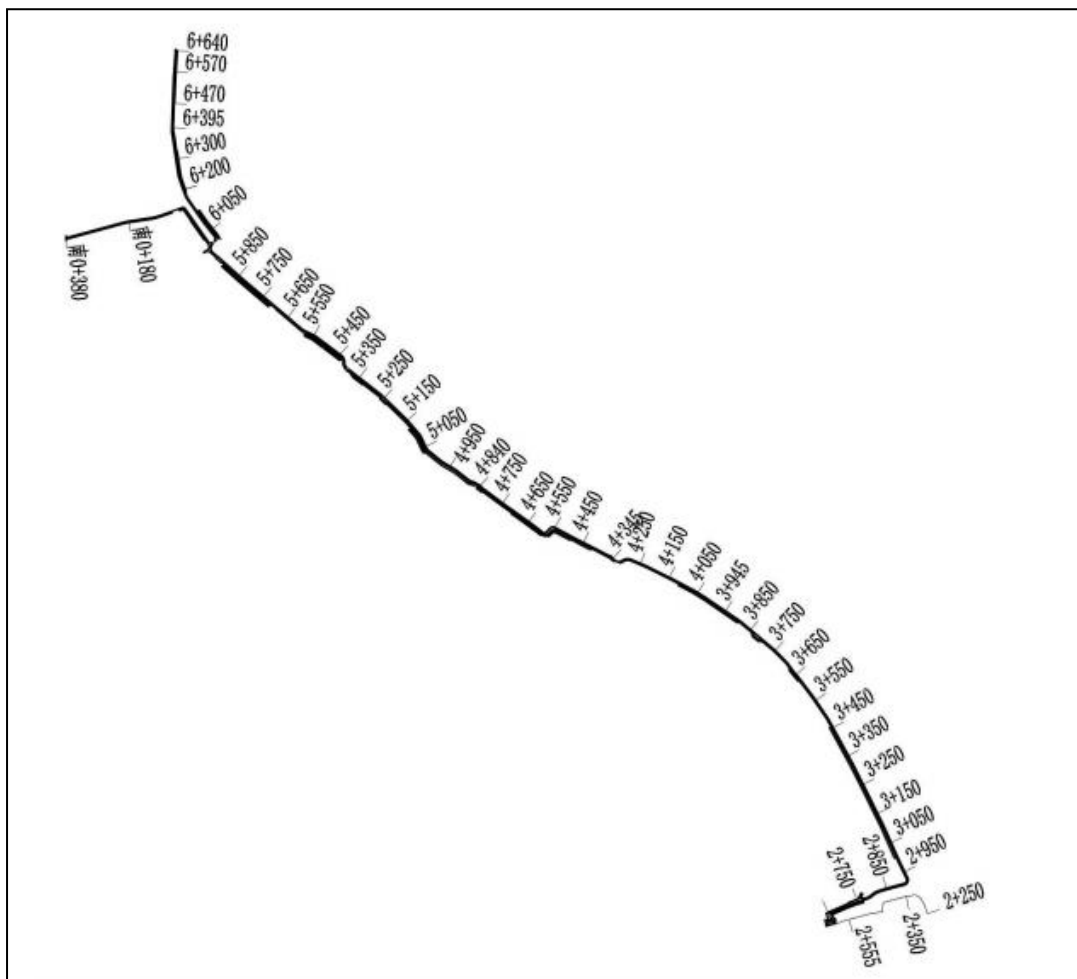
万丰围至鹅溪长山堤断面示意图
